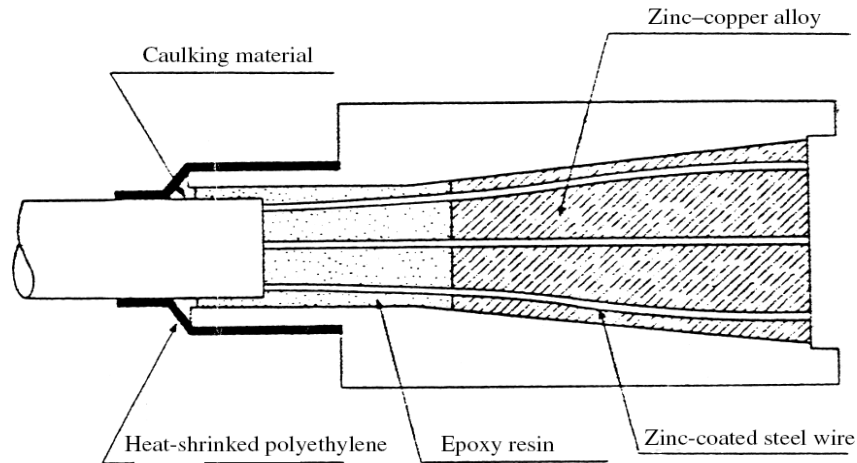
Cabeza de anclaje DINA (DINA Anchor Head)
